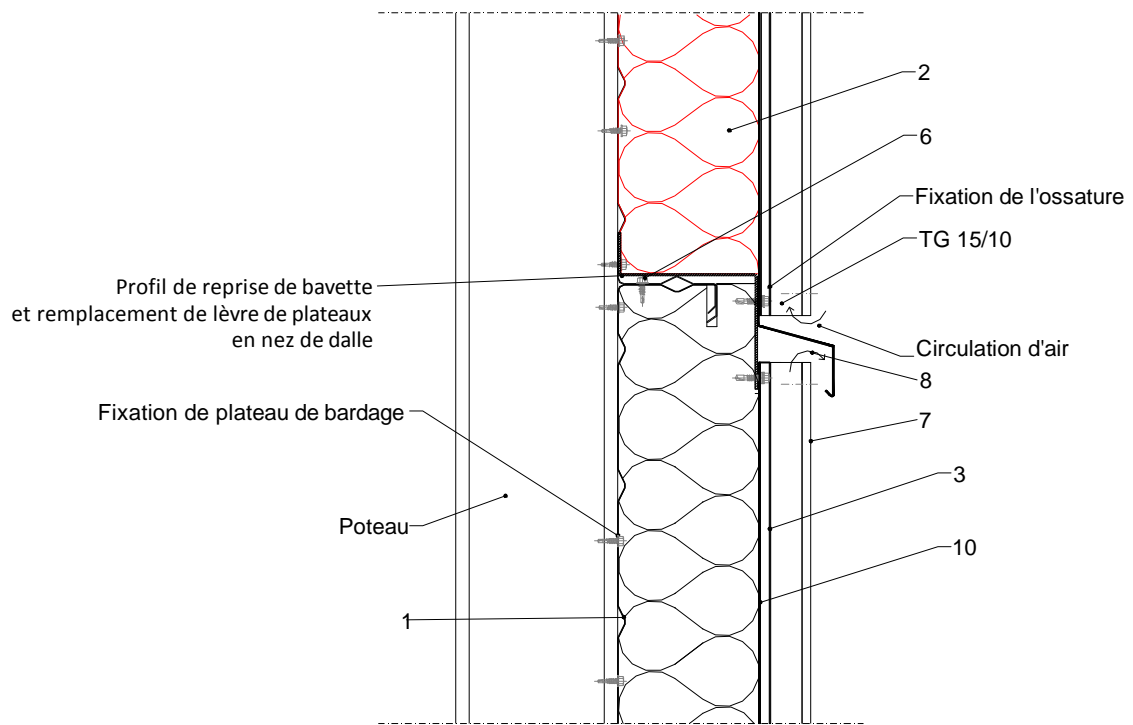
Fractionnement de lame d'air – Coupe verticale
